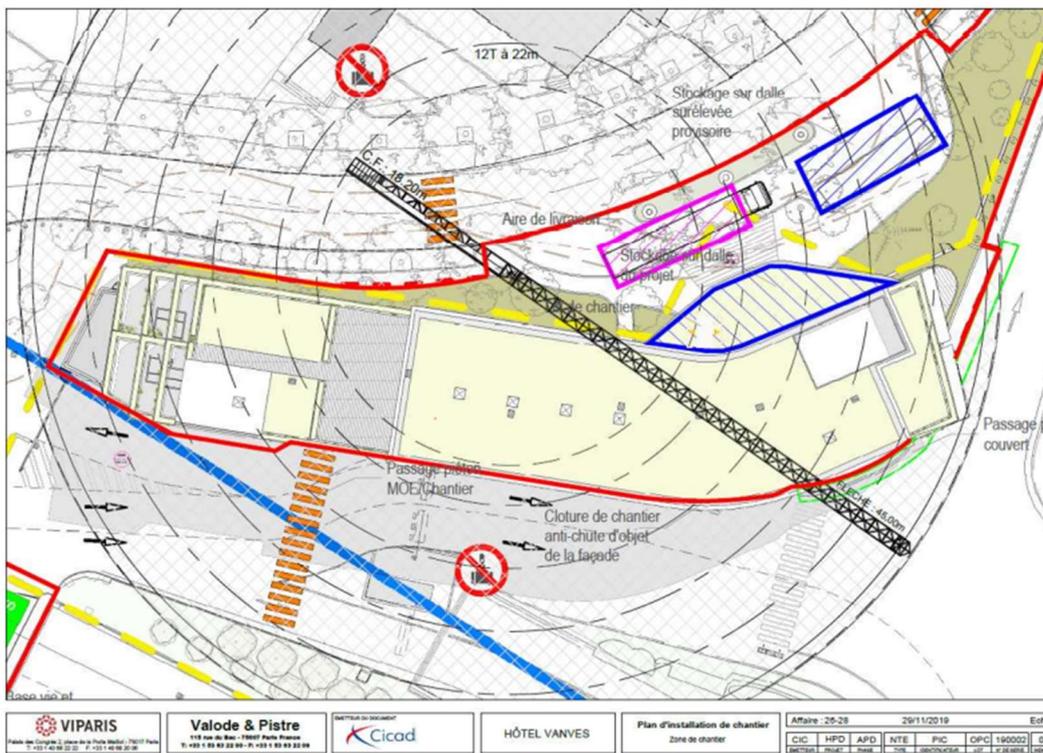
Plan d'installation de chantier de l'hôtel Vanves (Source : CICAD, novembre 2019)
